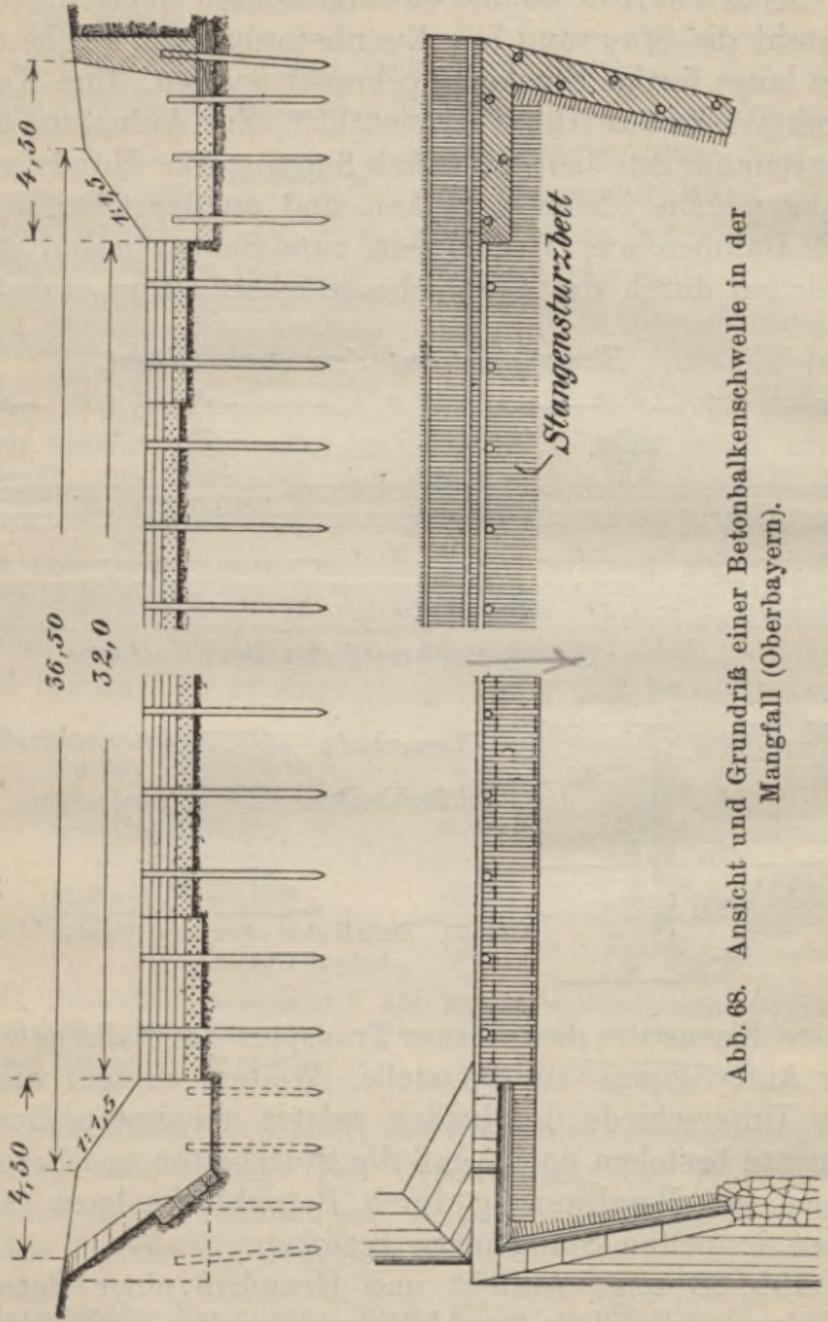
Ansicht und Grundriß einer Betonbalkenschwelle in der Mangfall (Oberbayern).
